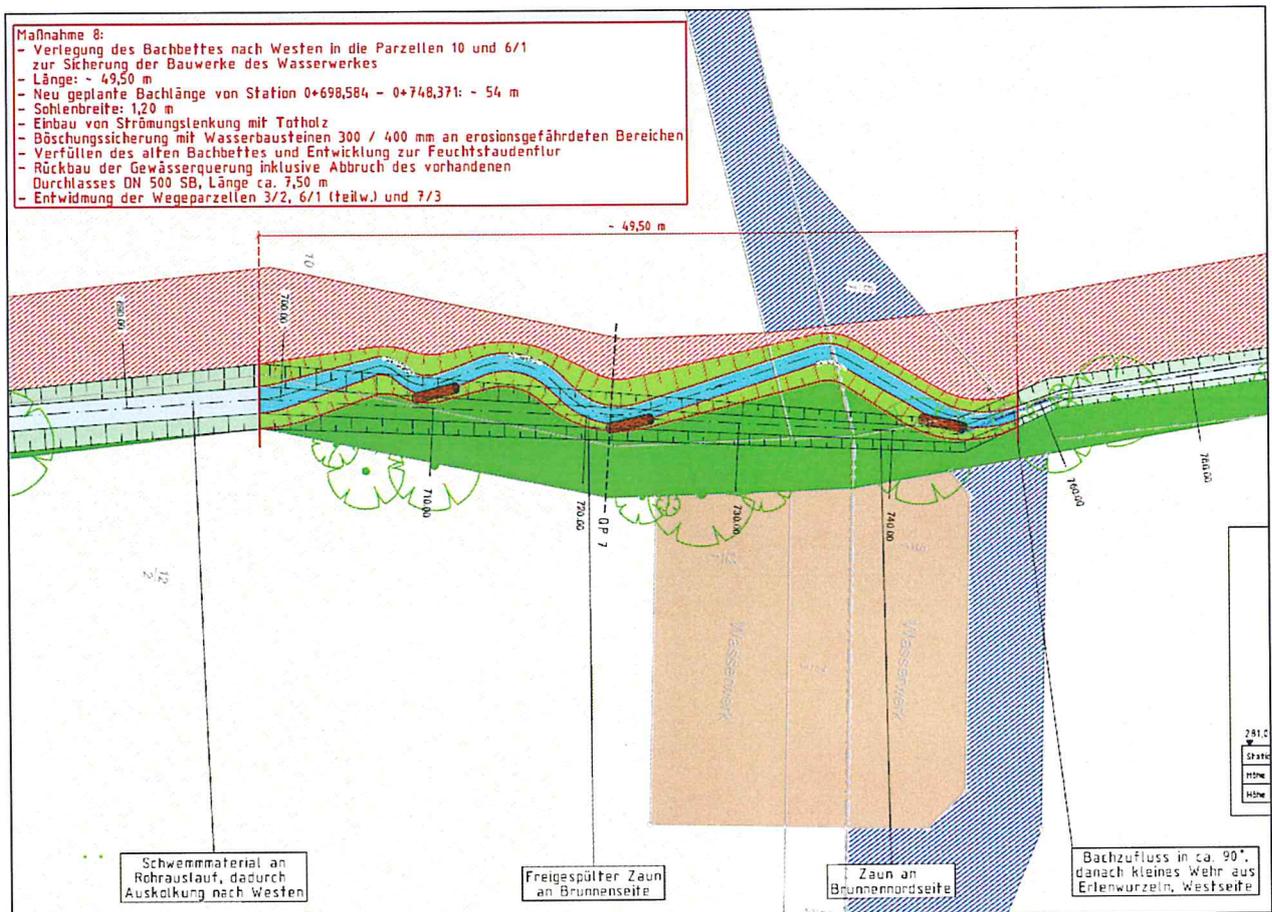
Ausschnitt (Maßnahme 8) aus Lageplan mit Querprofilen zum Renaturierungskonzept des Wörsbaches
